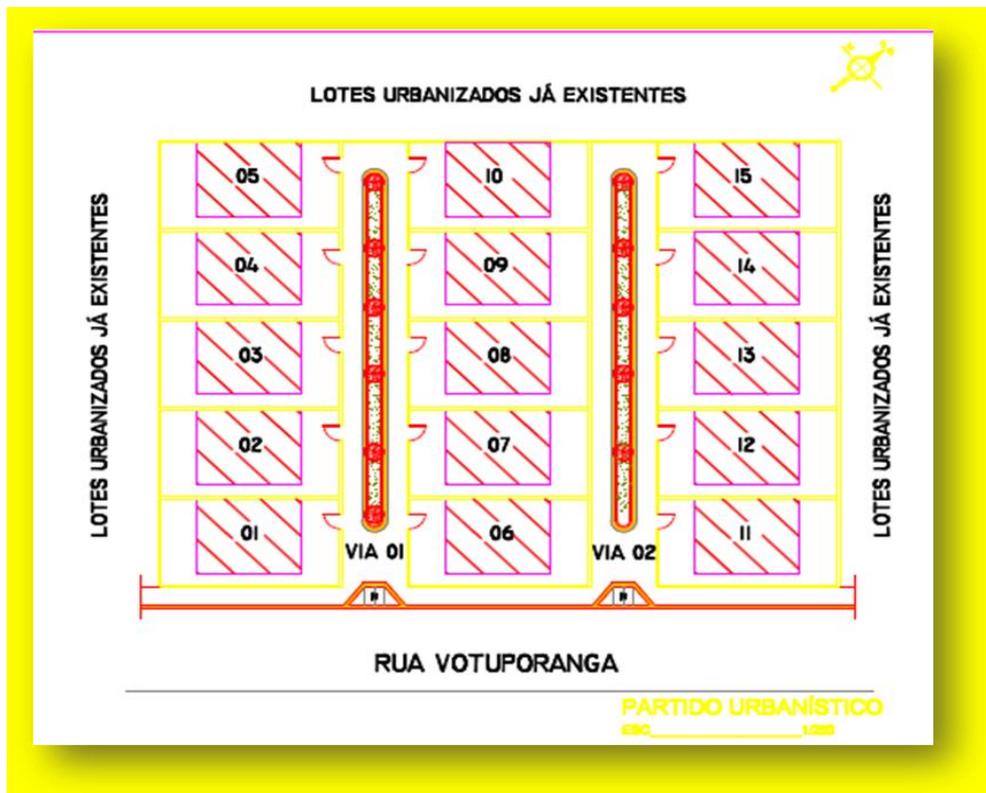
Planta baixa dos lotes destinada a realocação das famílias da Rua do Riacho.
